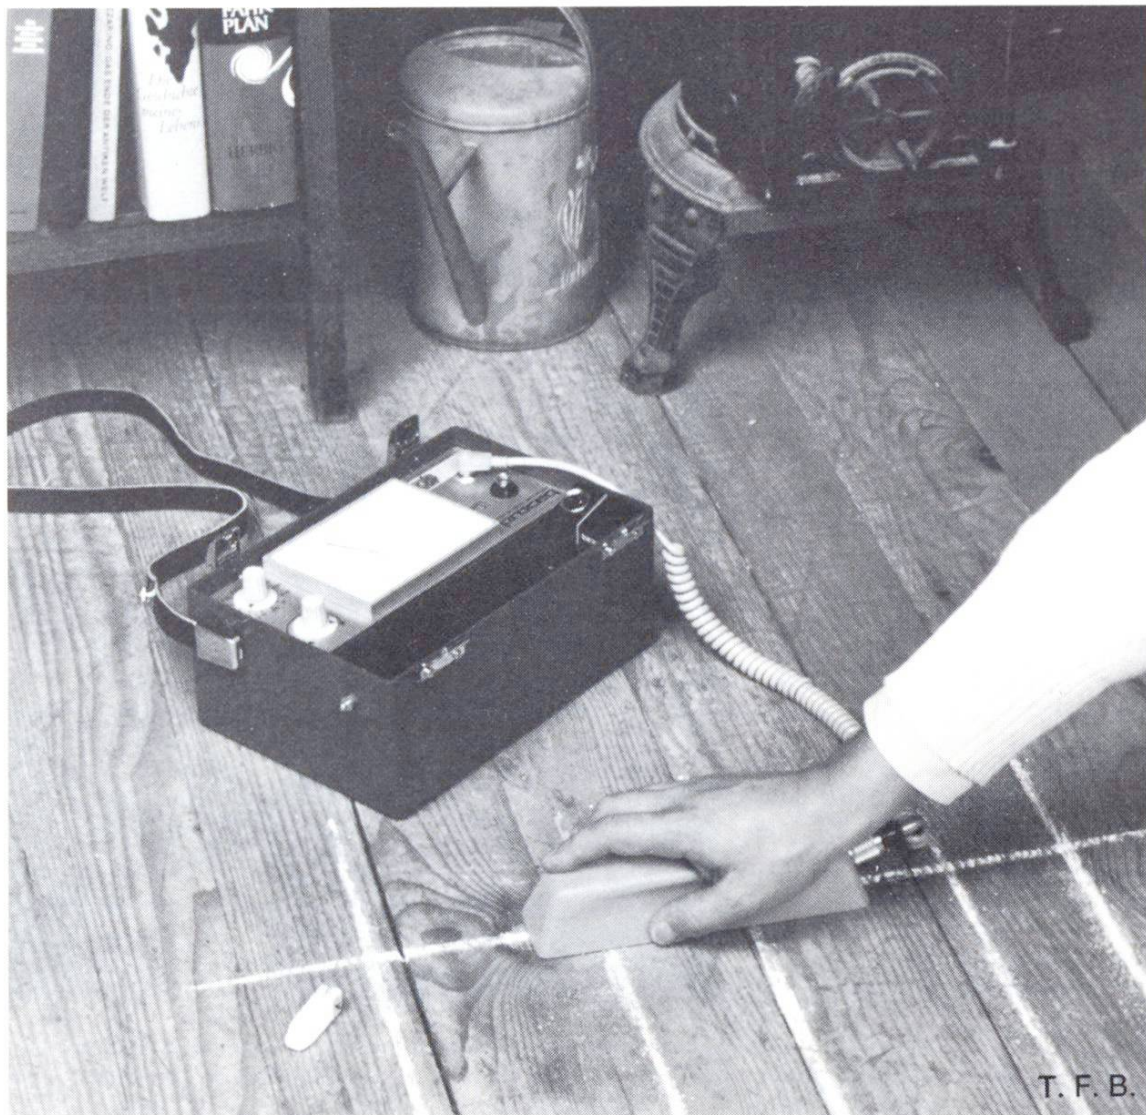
Bei einem Altbau kann mit der Tiefsonde ermittelt werden, ob es sich bei der Tragkonstruktion um armierten Beton handelt. Der Riemenboden muss dazu nicht entfernt werden.
